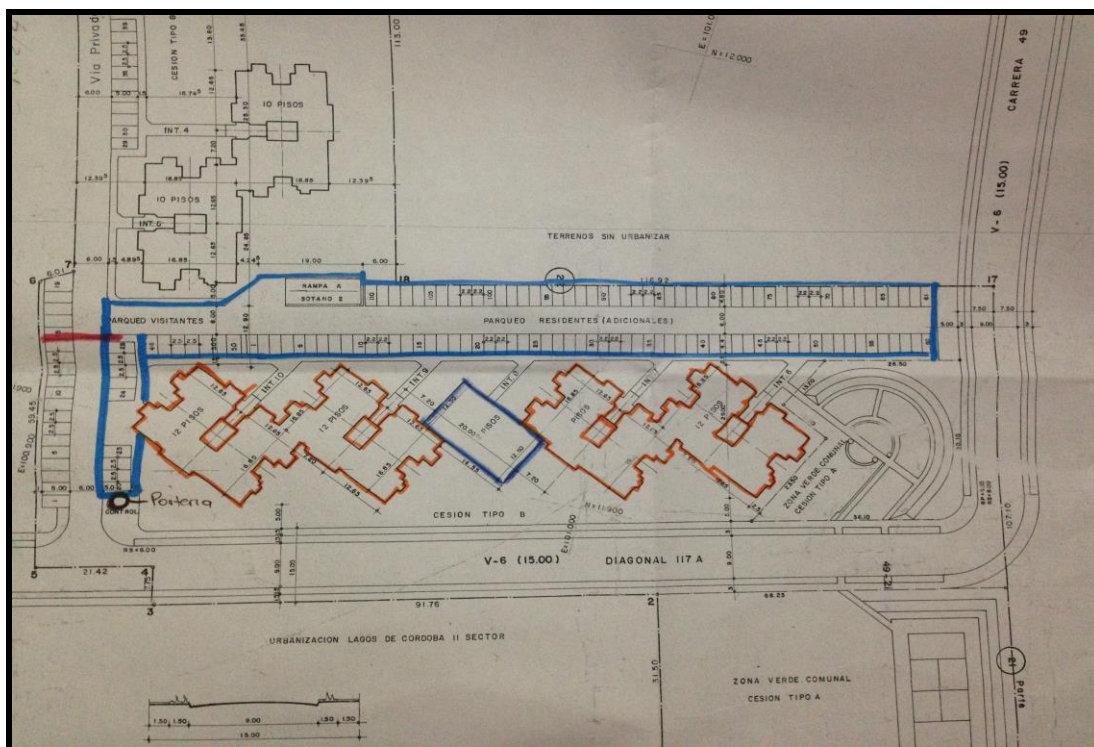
Plano de la cobertura del nuevo parqueadero. Fuente: construcción del autor
